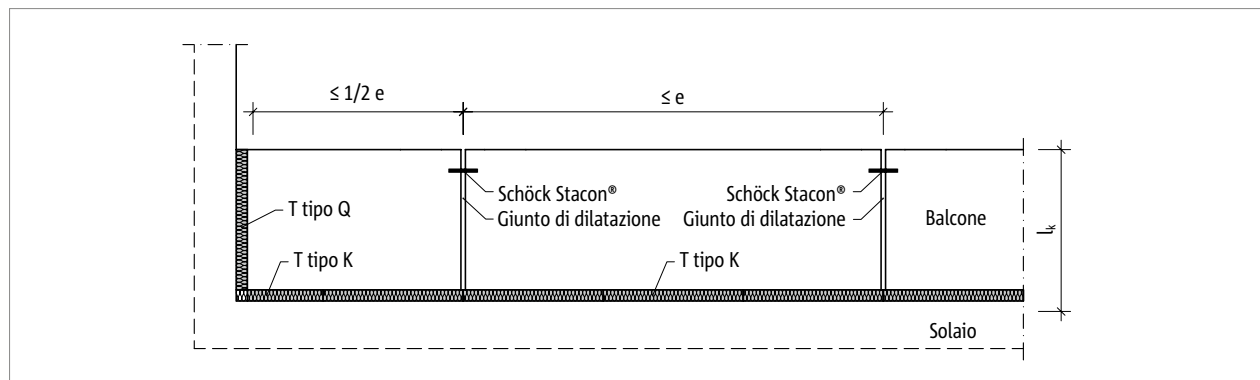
Schöck Isokorb® T tipo K: disposizione giunti di dilatazione
